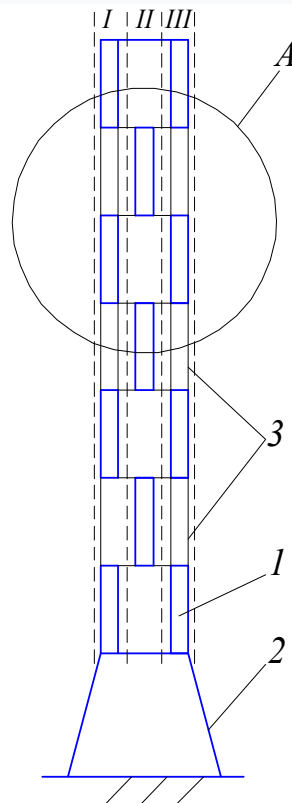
Звукопоглинальний комплекс (вид збоку рис. 2)
